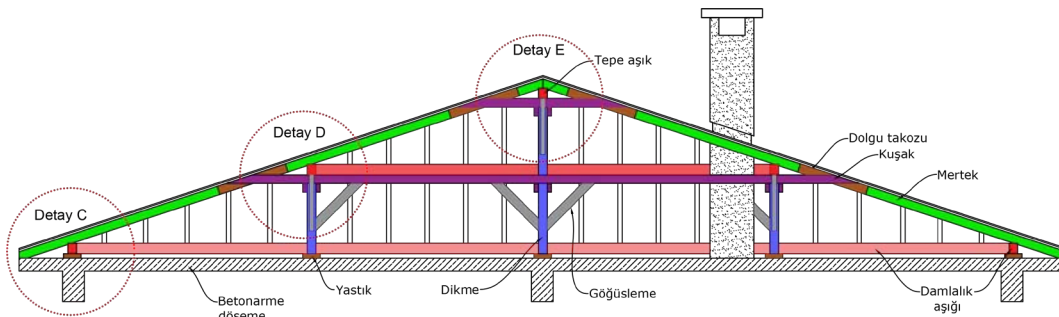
Kıрма çatı taşıyıcı sistem planı
